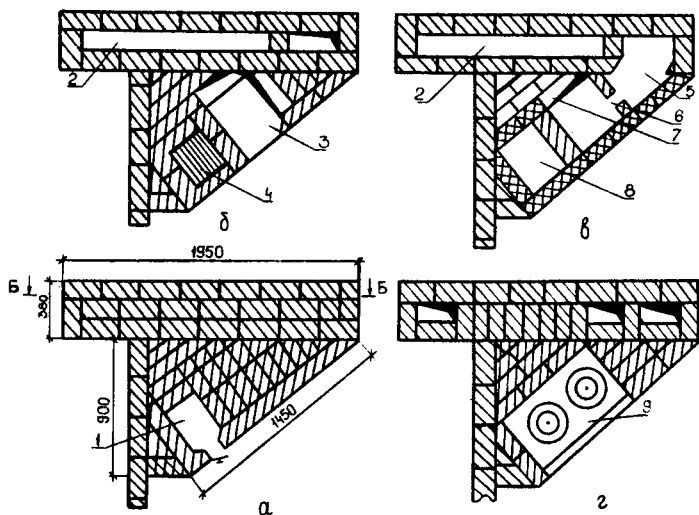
Кладка печи № 3 с 1-го по 12-й ряд: а — 1—4-й ряды; б — 5—7-й ряды; в — 8—11-й ряды; г — 12-й ряд; 1 — зольник; 2 — первый горизонтальный канал; 3 — духовка; 4 — колосники; 5 — первый жаровой канал; 6 — подсосный канал, 7 — опускной канал; 8 — топливник; 9 — плита
